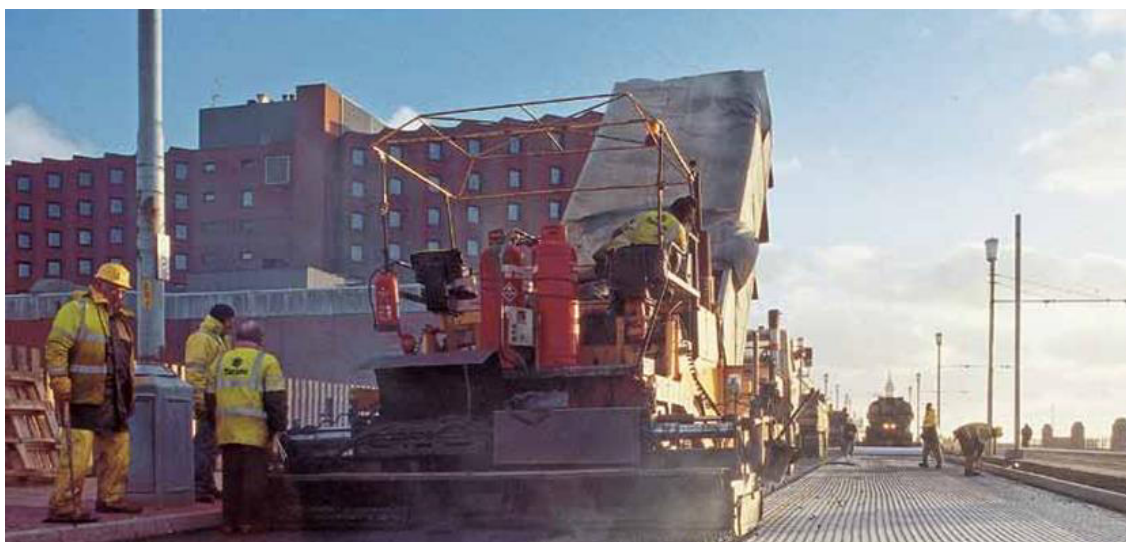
Aplicação de grelhas para o controlo a formação de fissuras no asfalto (Pavimentos asfálticos, Tensar)
